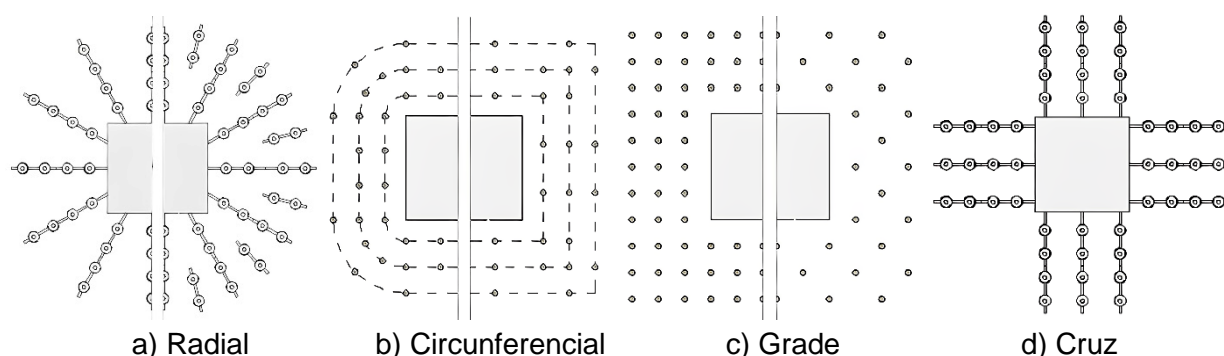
Arranjos das armaduras de cisalhamento (PEREIRA FILHO, 2016).
